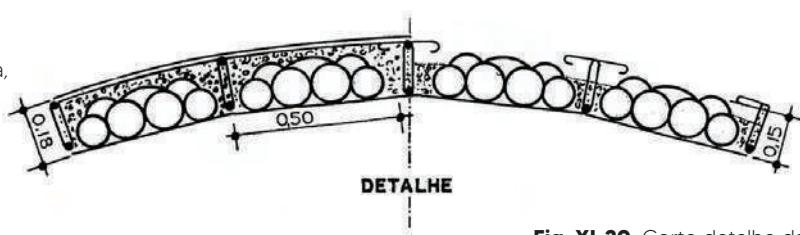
Corte detalhe da onda. Observe as armaduras e a camada de 3 cm. de concreto. (*-13, redesenrado por *-5).
